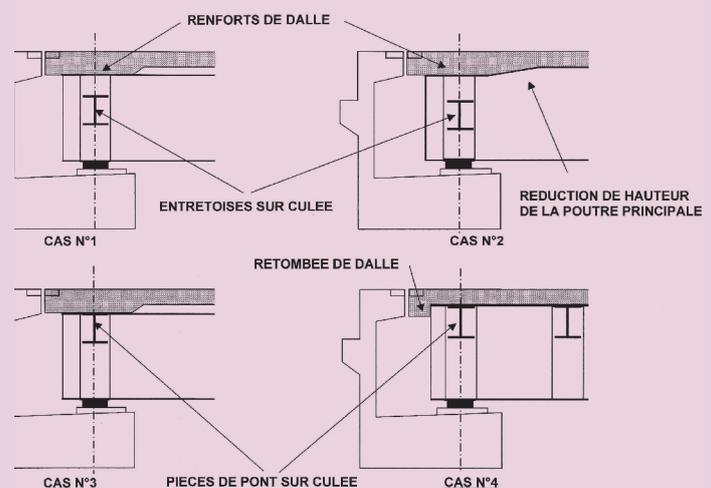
Renforts de la dalle au droit d'un joint de chaussée
